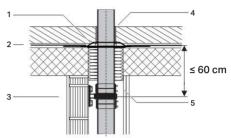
Traversée de dalle avec étanchéité contre l'humidité
